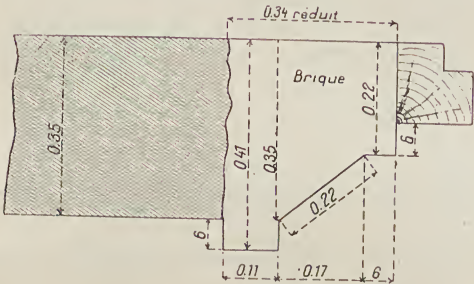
Coupe sur AB du piédroit de la baie p.
